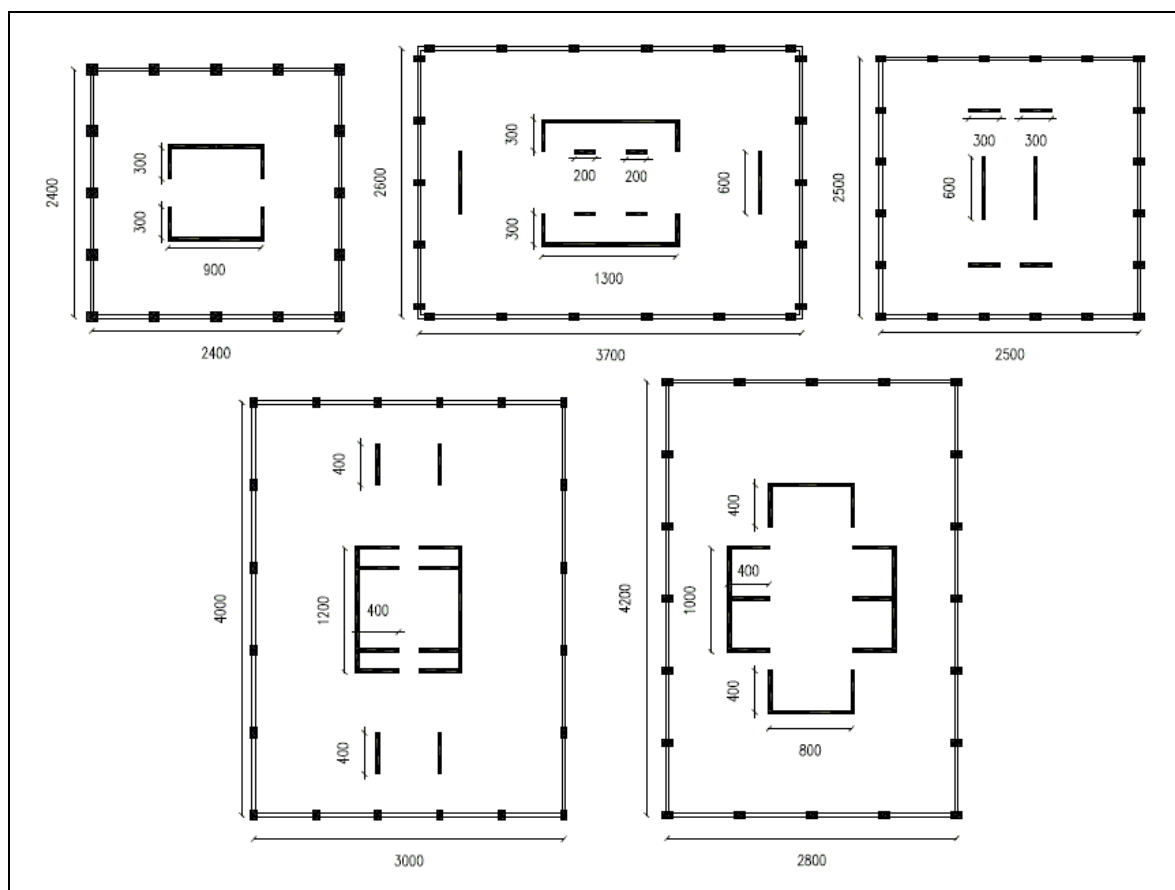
Prototipo de plantas estructurales utilizadas en base de datos, planta libre
